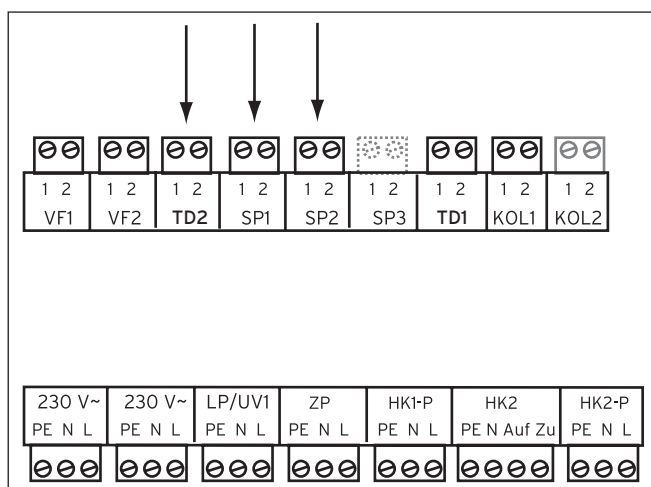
Cablaggio della centralina dell'impianto solare
